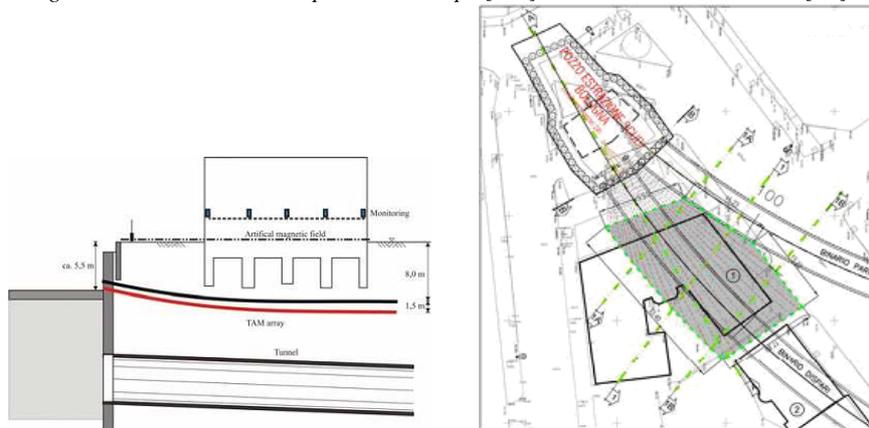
Sezione e planimetria dell'edificio e del pozzo in Piazza Bologna
